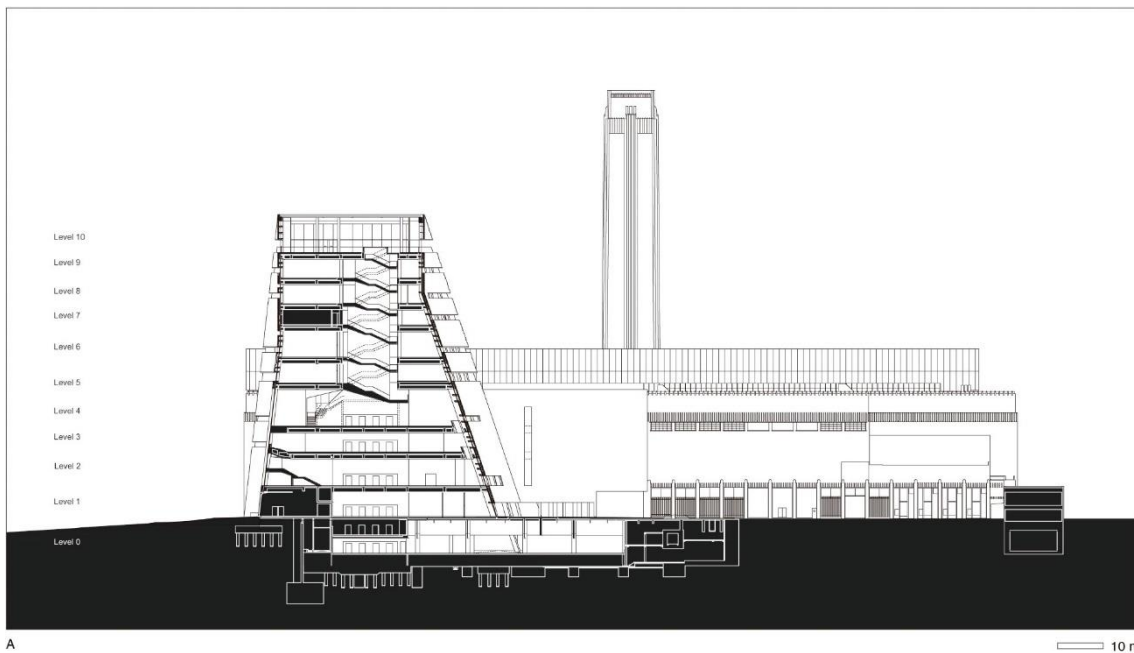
Corte arquitectónico del edificio Tate Modern.
